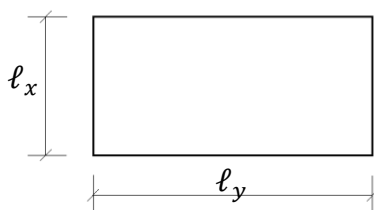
Vãos da laje retangular armada em uma direção.
